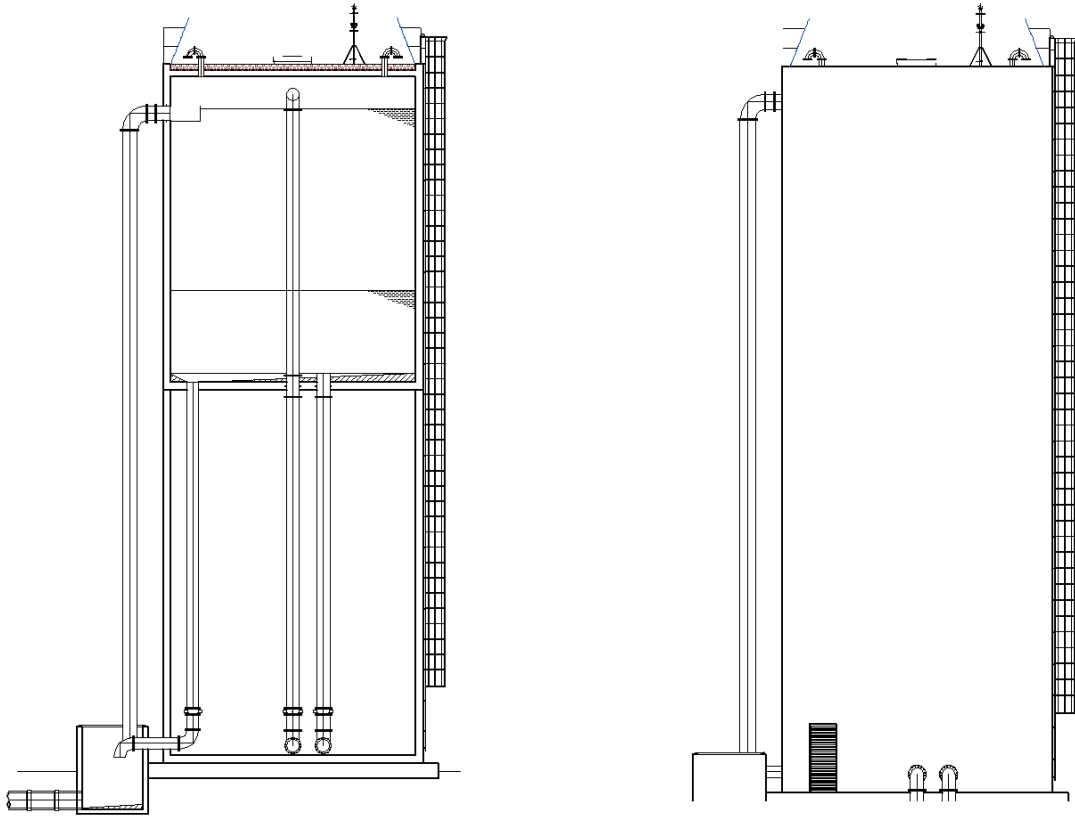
Esquemas em corte do reservatório circular elevado de concreto (Reservatório Tipo 2)
